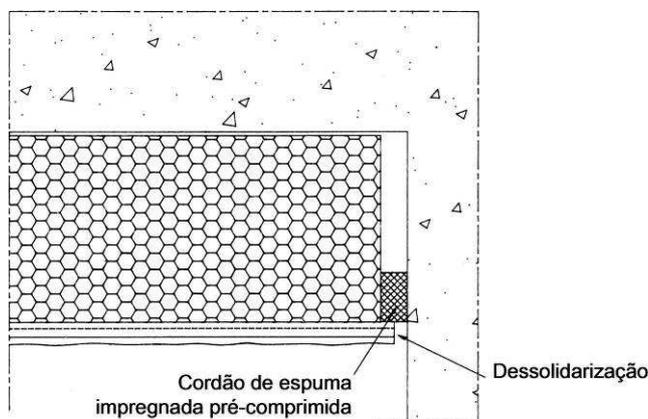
Ligação do sistema com elementos construtivos salientes (corte horizontal) [3]
